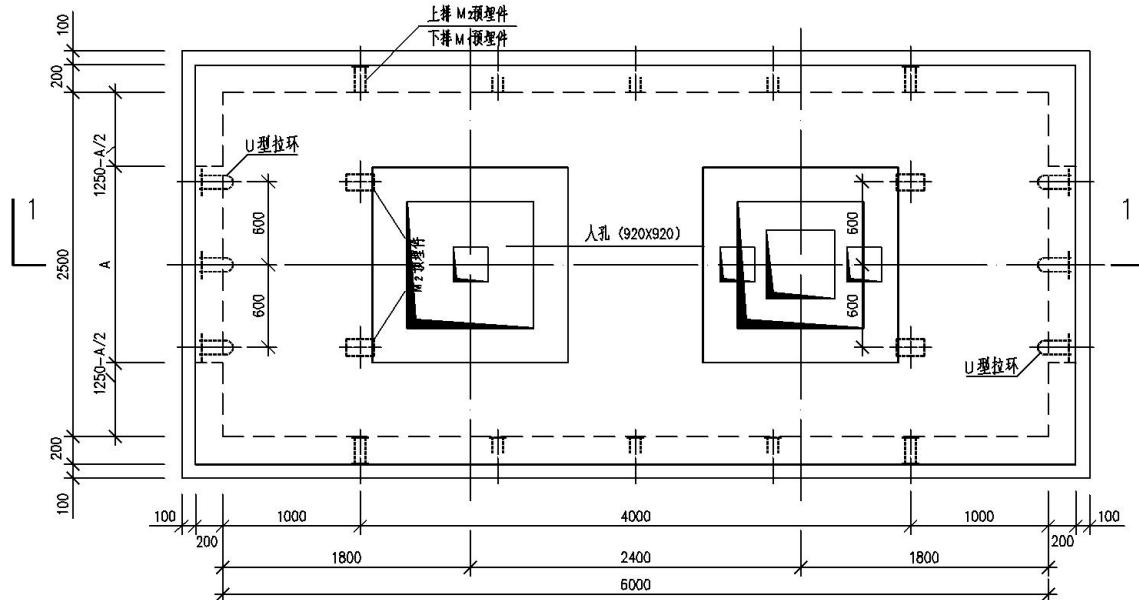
直线工井平面图 (6.0m×2.5m×1.9m)
